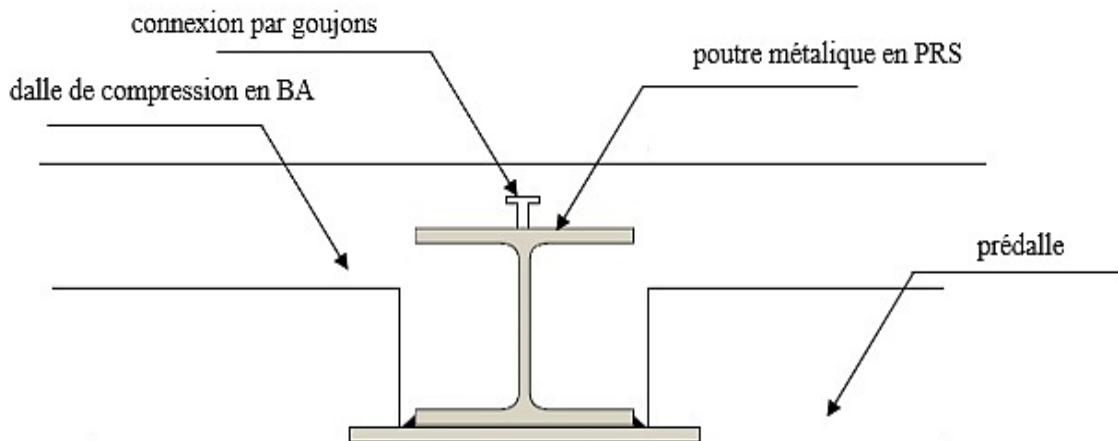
coupe en plancher mixte mince à poutres intégrées.
